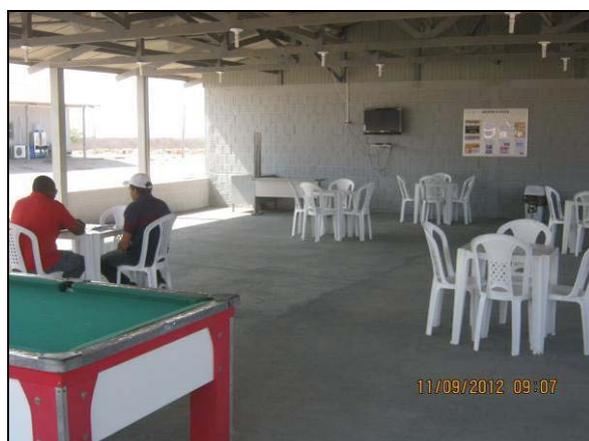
Área reservada para o descanso e lazer dos colaboradores no canteiro de obras (set/2012).
